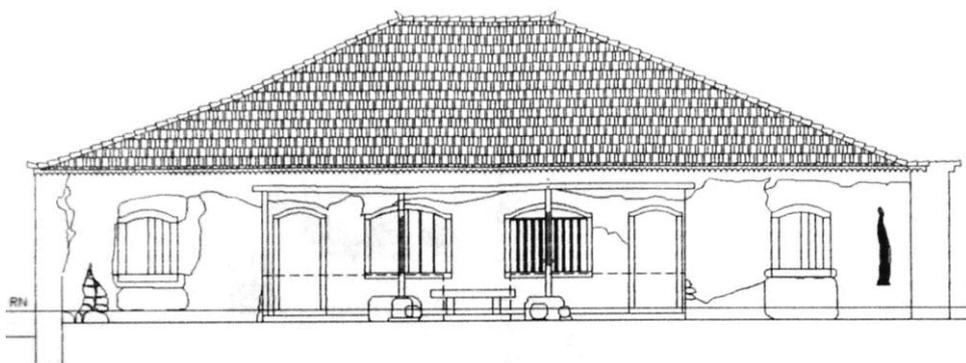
Foto digital da Fachada Principal da antiga sede da fazenda: levantamento de 1988.
